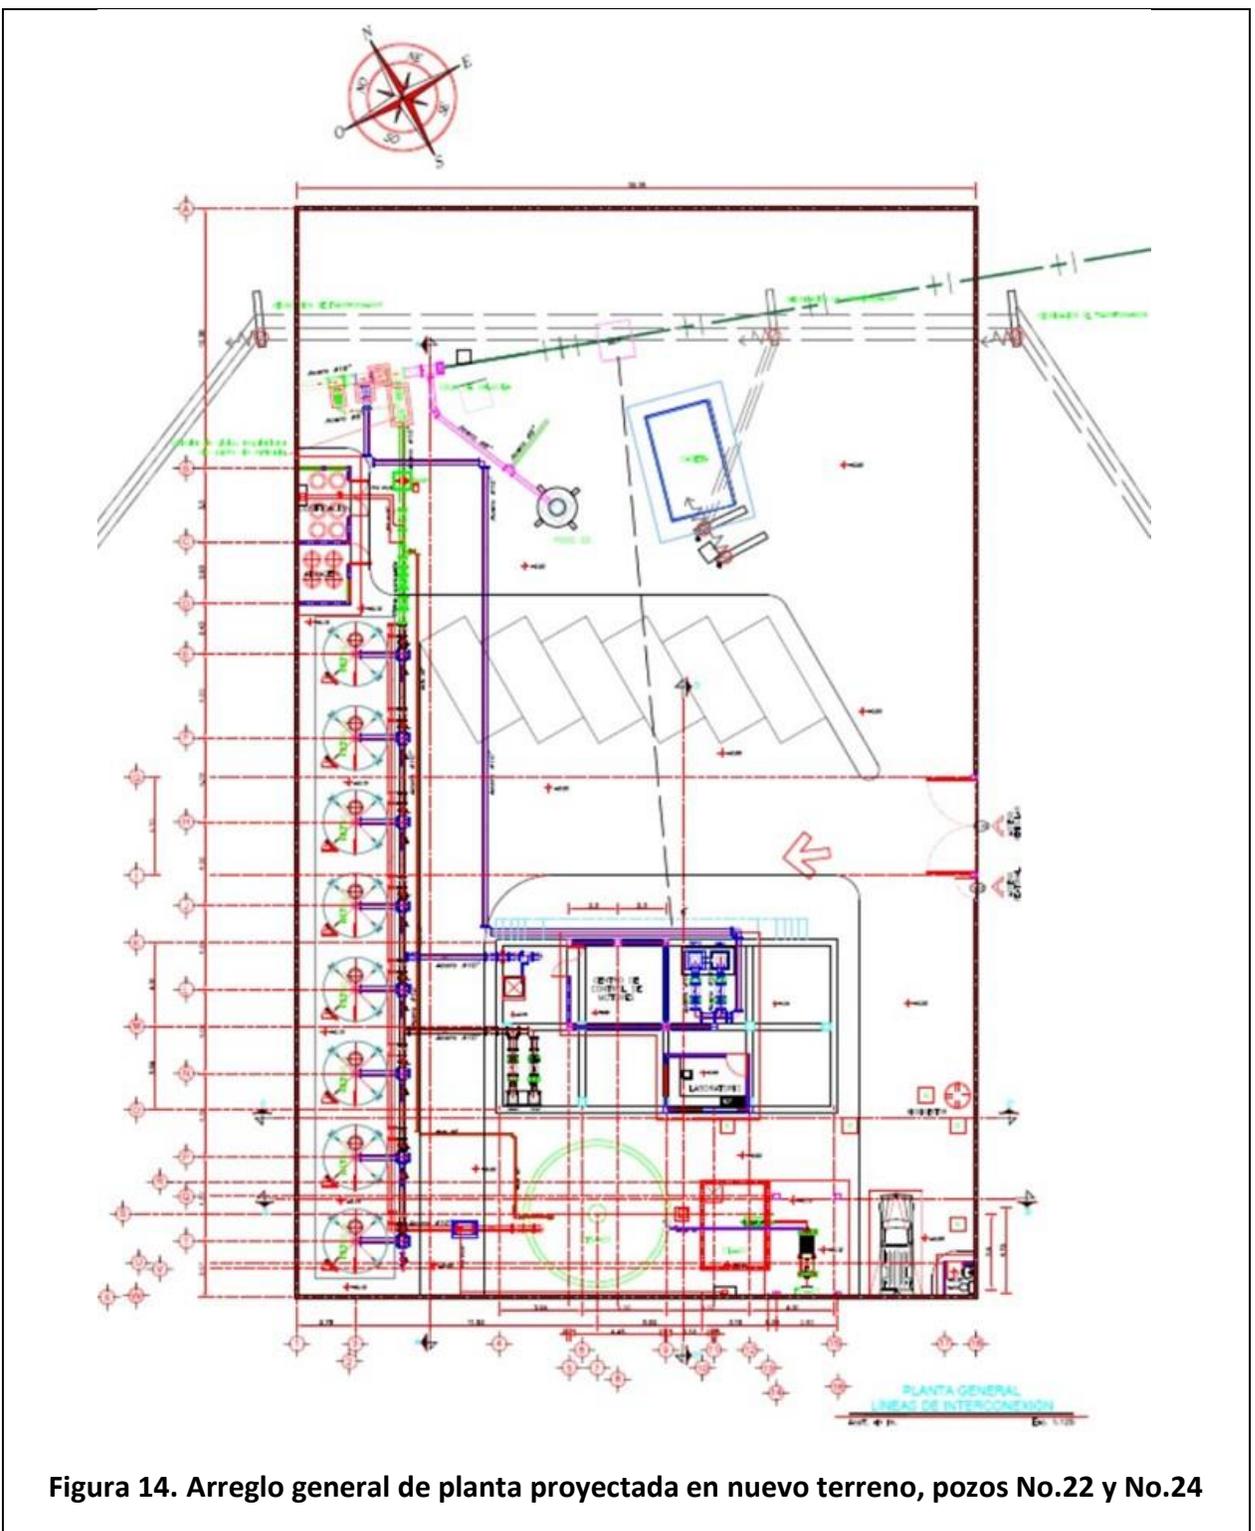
Arreglo general de planta proyectada en nuevo terreno, pozos No.22 y No.24
